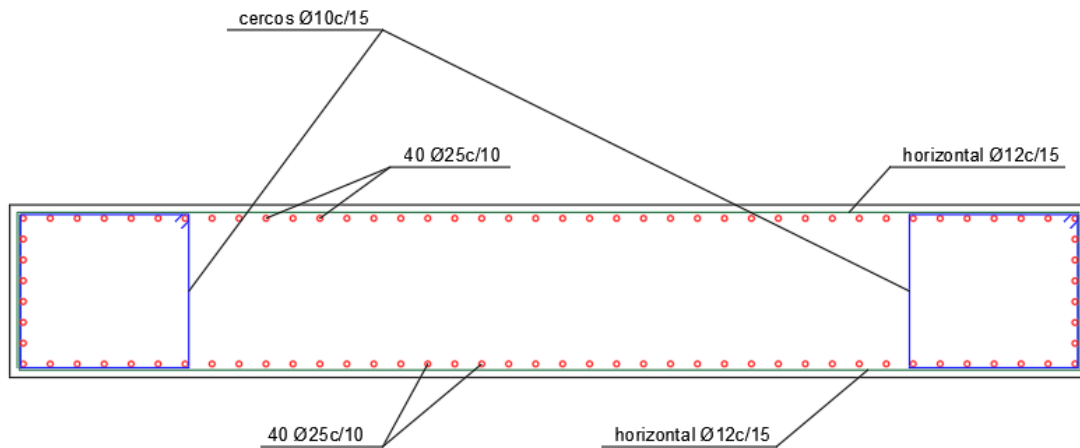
Armado tipo para las columnas fuera de la rótula plástica
